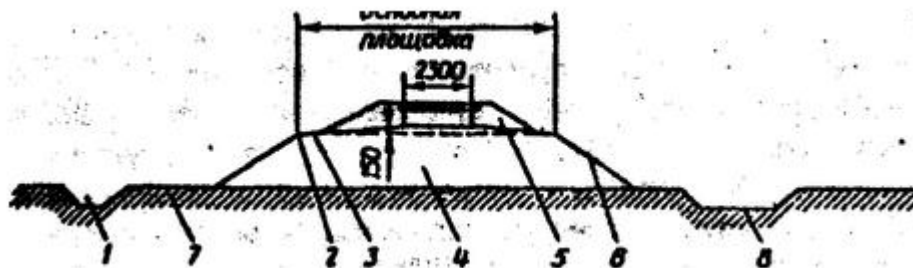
Поперечный профиль однопутной насыпи: 1 - водоотводная канава; 2 - бровка; 3 - обочина; 4 - земляное полотно; 5 - балластный слой; 6 - откос; 7 - берма; 8 - резерв
